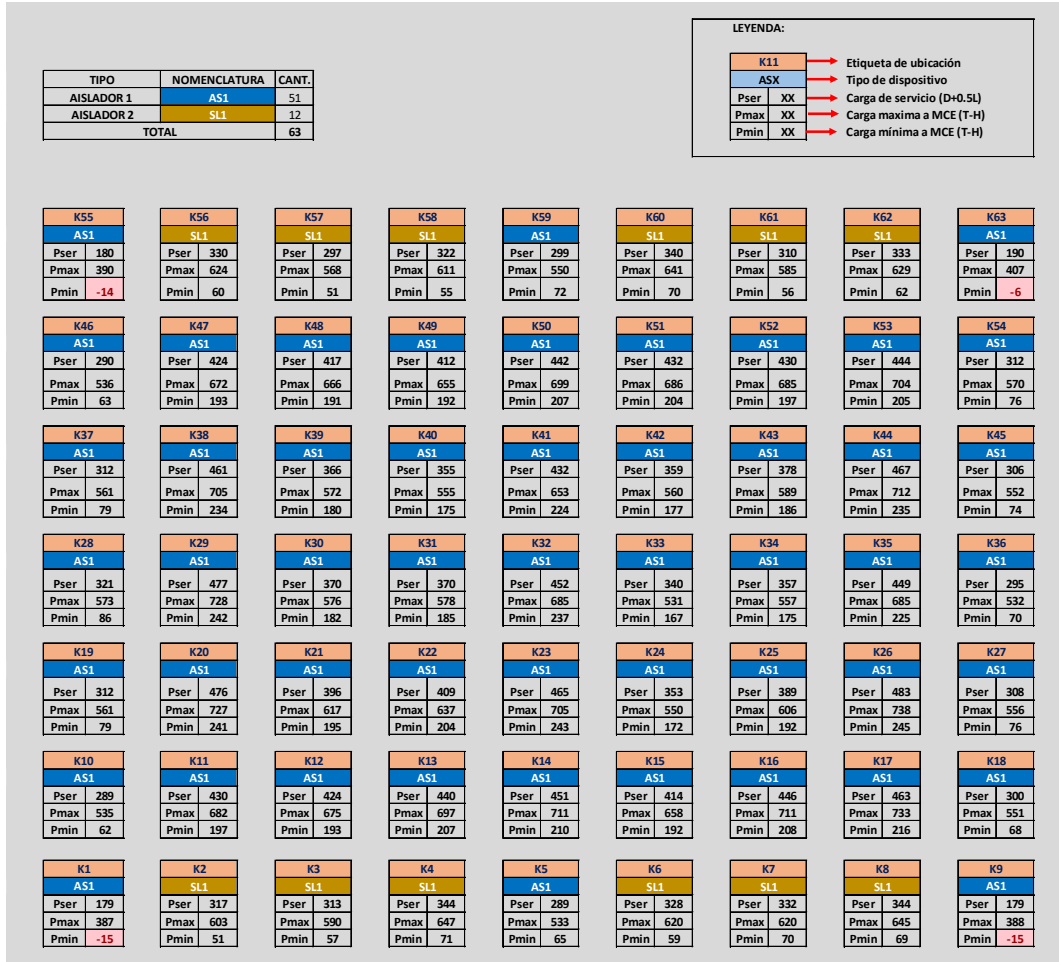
“Esquema en planta de la distribución de unidades de aislamiento”
